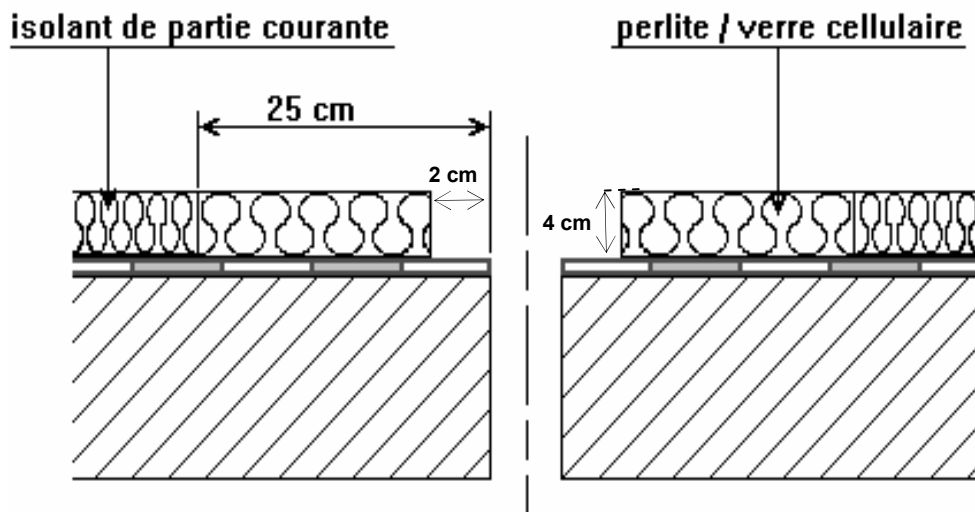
Terrasses accessibles aux piétons et séjour - feuillure sur support isolant rapporté
